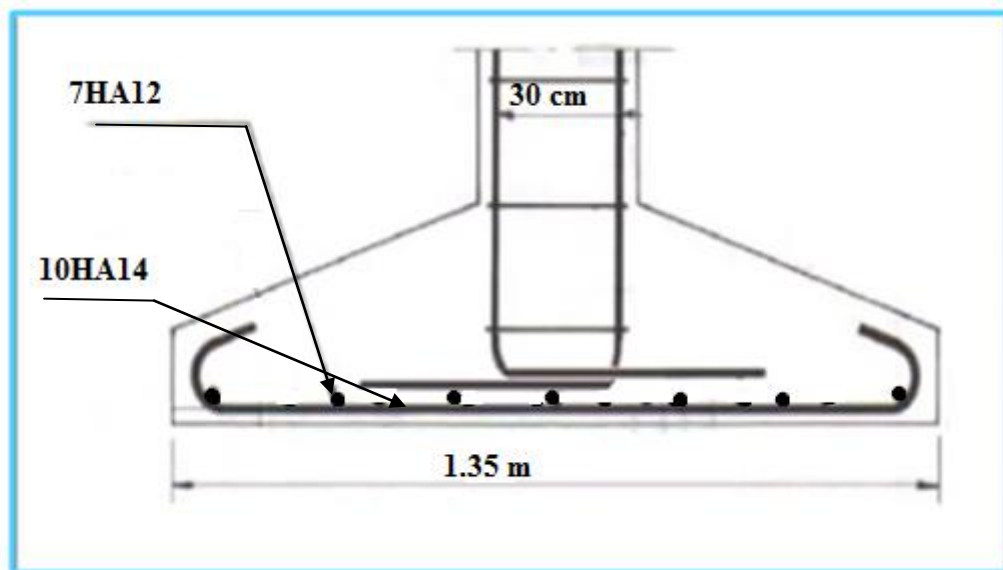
Ferrailage de la semelle isolée sous poteau (30*40) sans X-X.
